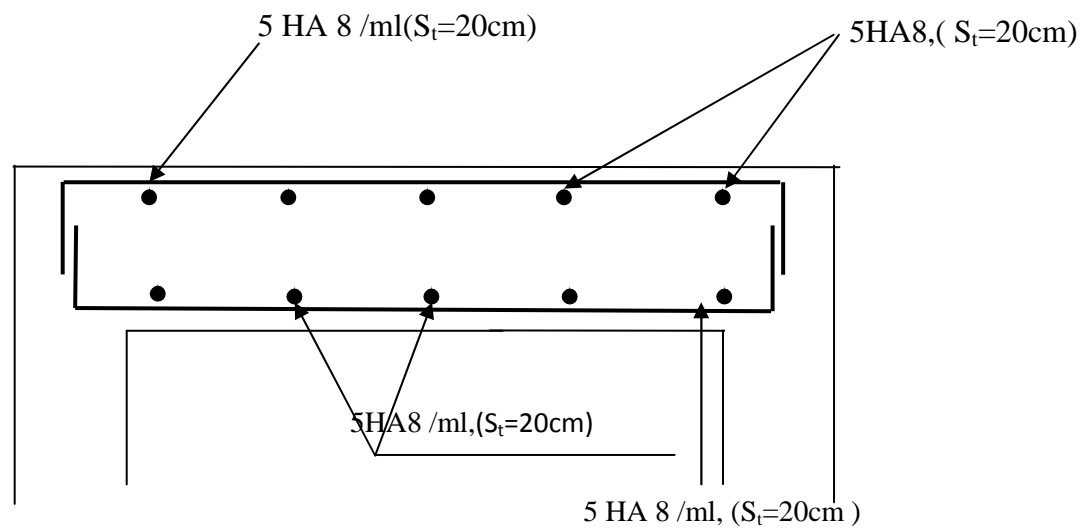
Ferrailage de la dalle pleine de la salle machine dans le sens x-x.
